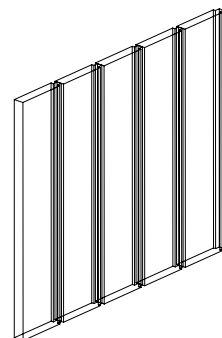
Parede de madeira simples do tipo macho e fêmea.
